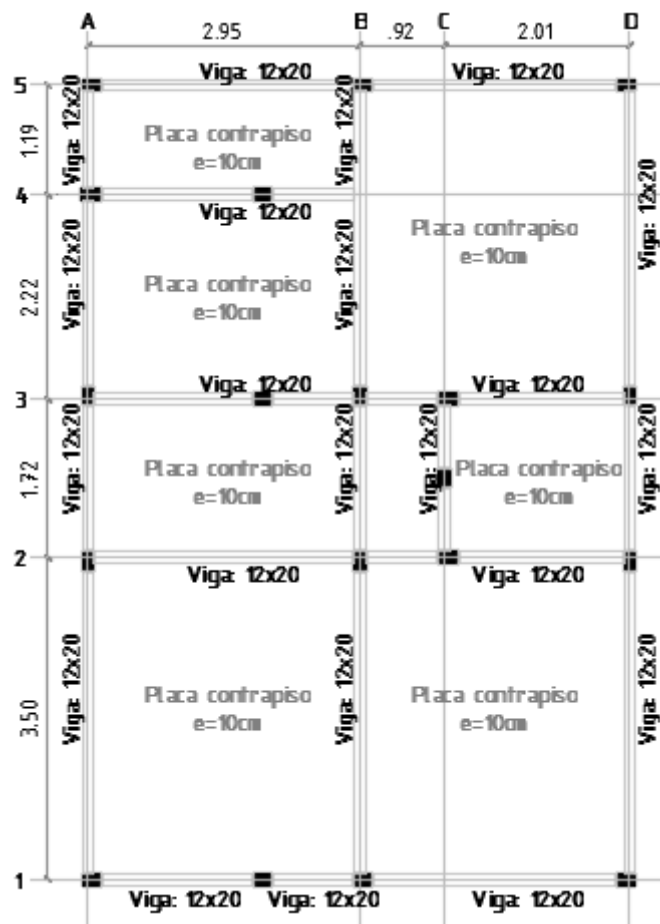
Configuración en planta de vigas de amarre a nivel de terreno
